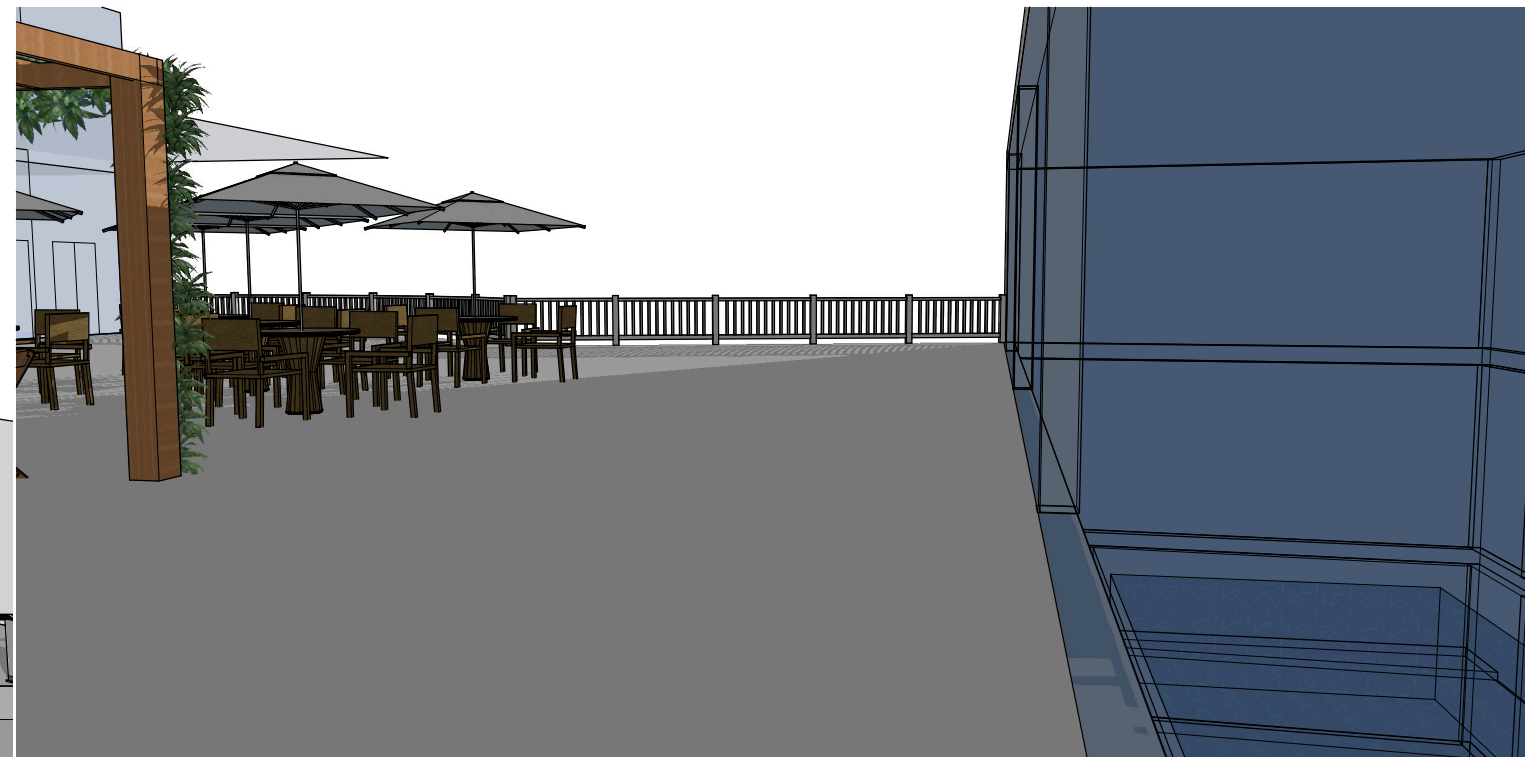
VISTA DAFACHADA DESDE ARUA AUGUSTA
